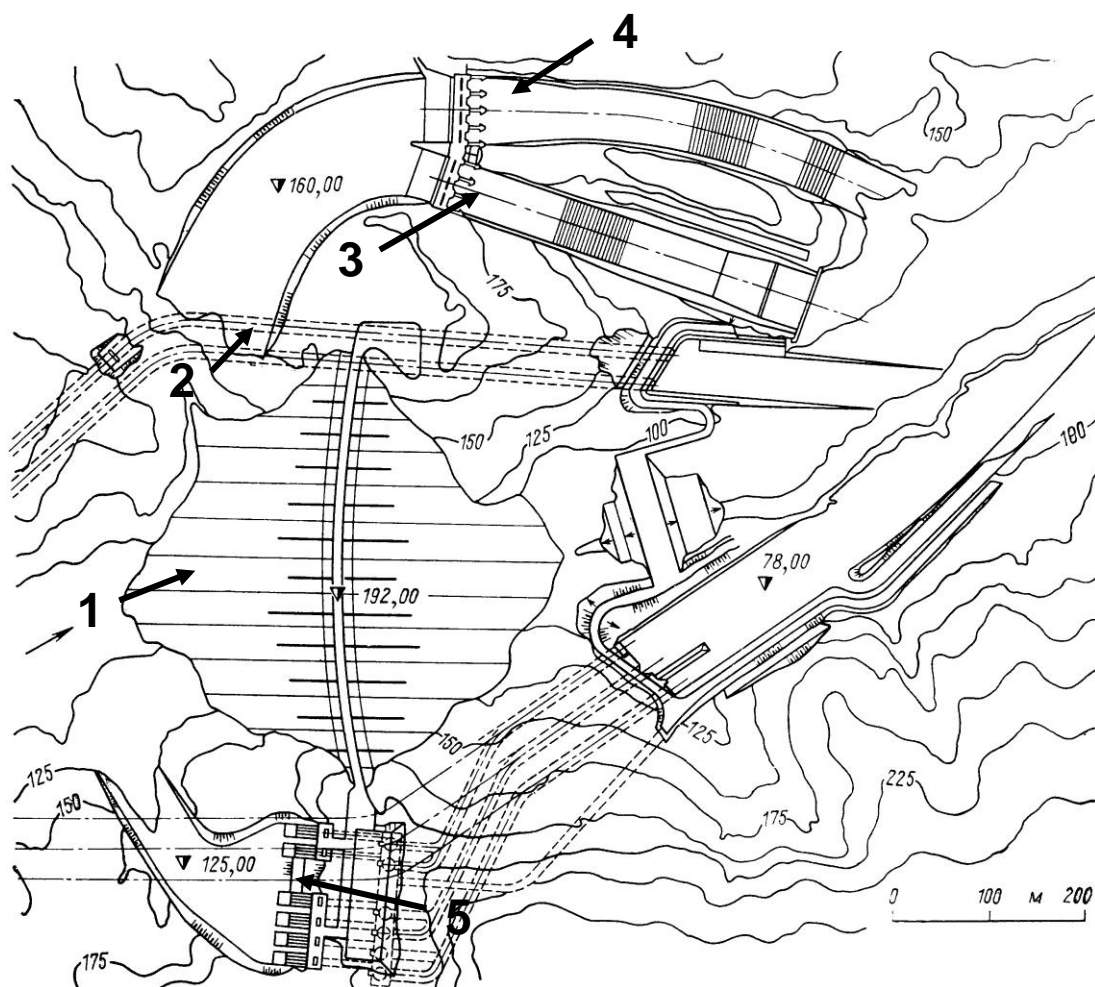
Компонировочная схема гидроузла Мальпансо (Мексика) с регулируемыми открытыми береговыми водосбросами (основным и резервным) и грунтовой плотиной: 1 – каменно-земляная плотина; 2 – строительный водосброс; 3 – эксплуатационный основной водосброс; 4 – эксплуатационный резервный водосброс; 5 – ГЭС
